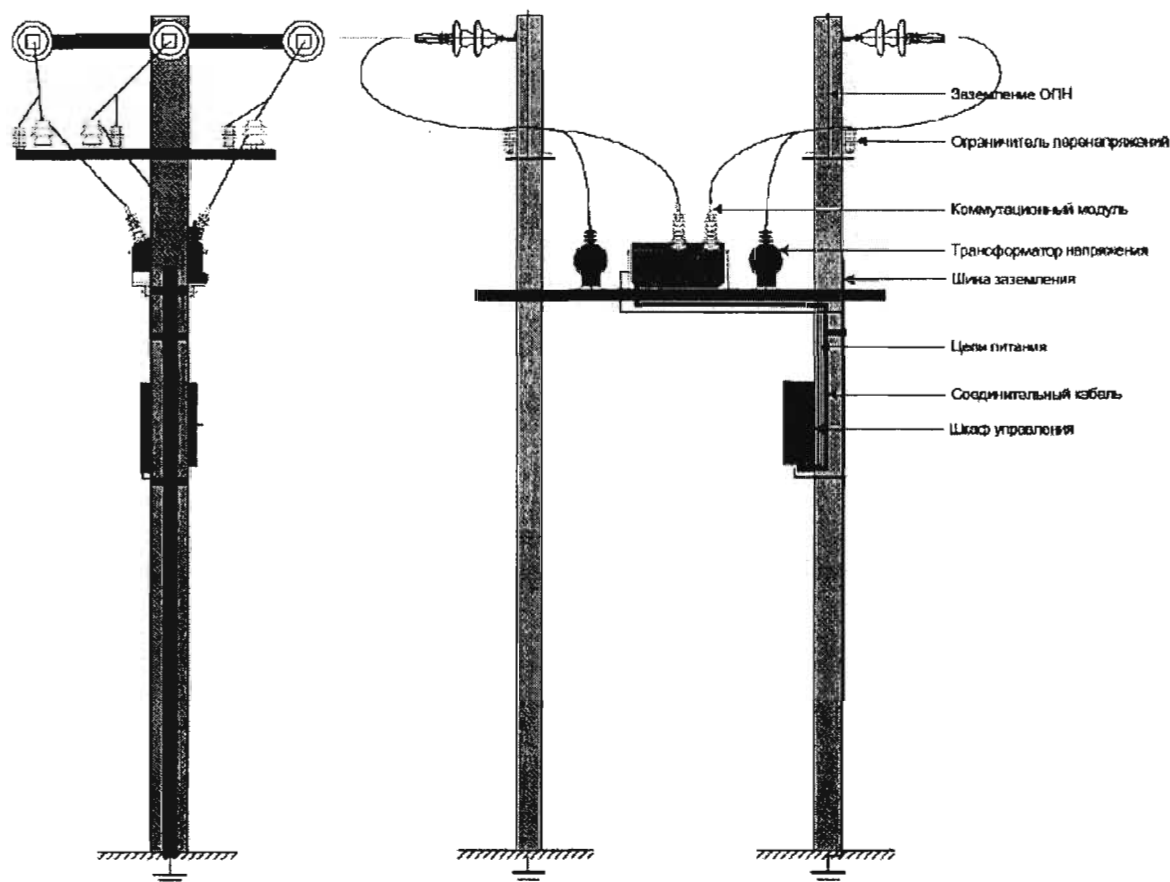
Схема установки РВА/TEL на железобетонные опоры СВ110-3,5
